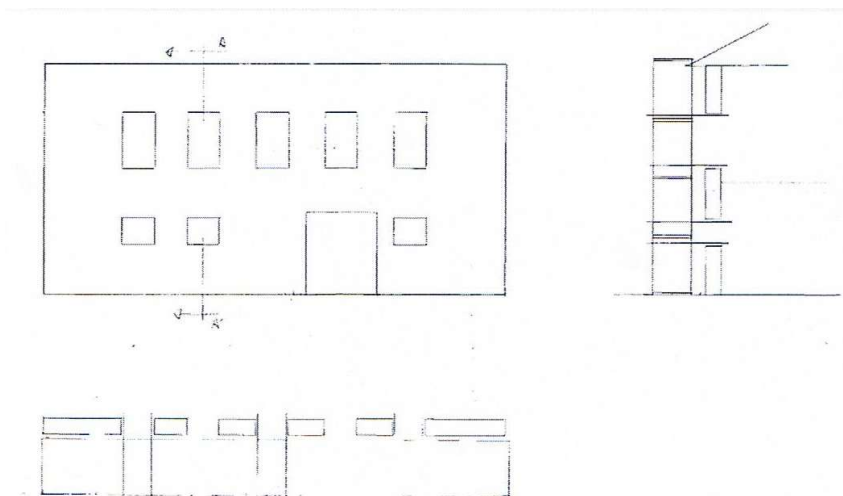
Puesta a escala de la fachada a estabilizar (vista de alzado, sección de perfil y sección de planta).
